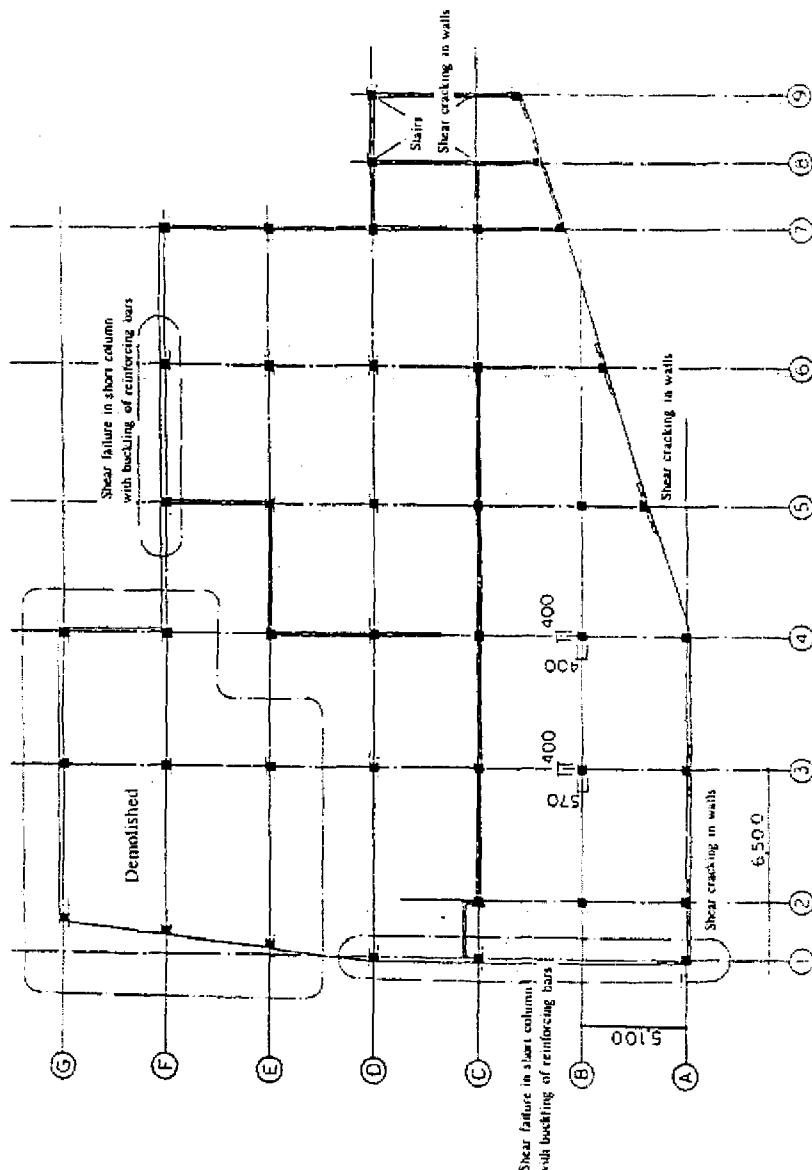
Plano estructural del complejo de Impresos López [2].
